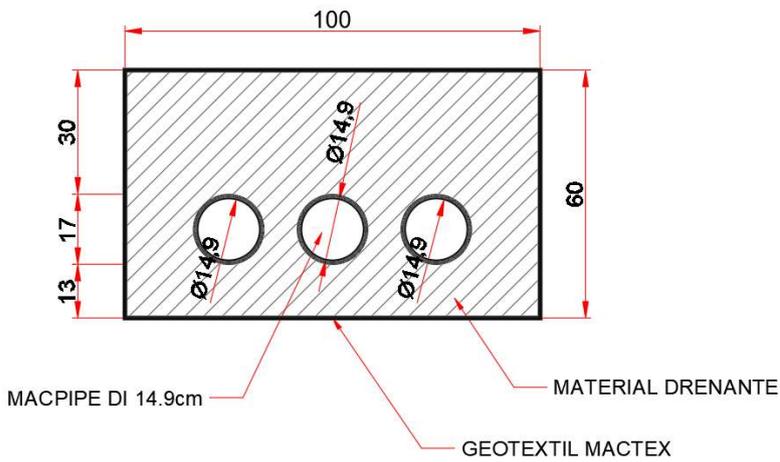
Detalhe: Drenagem Profunda. Fonte: WEGG PONTA GROSSA, 2017.
